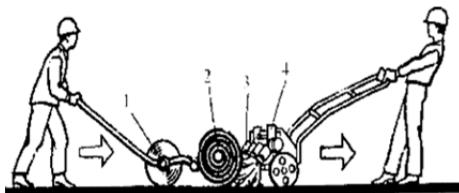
Установка для наклеивания наплавленного рубероида путём разогрева кровного слоя: 1 - каток; 2- рулон; 3- горелки; 4- установка
